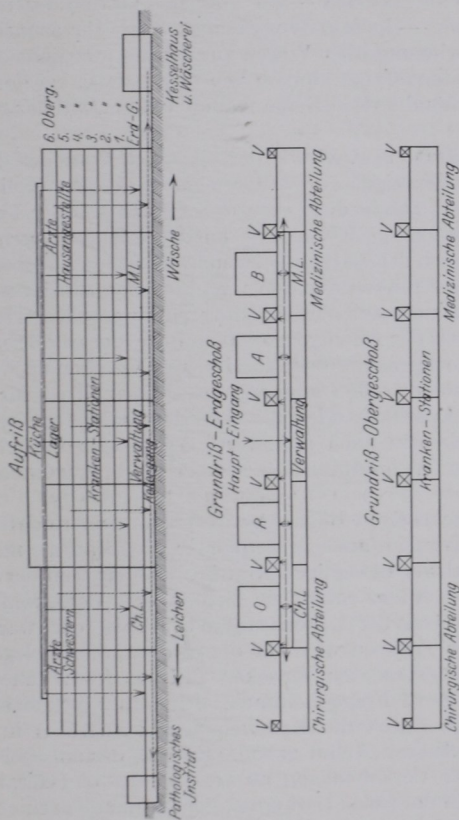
Schematischer Plan eines langgestreckten Krankenhaushochbaues.
